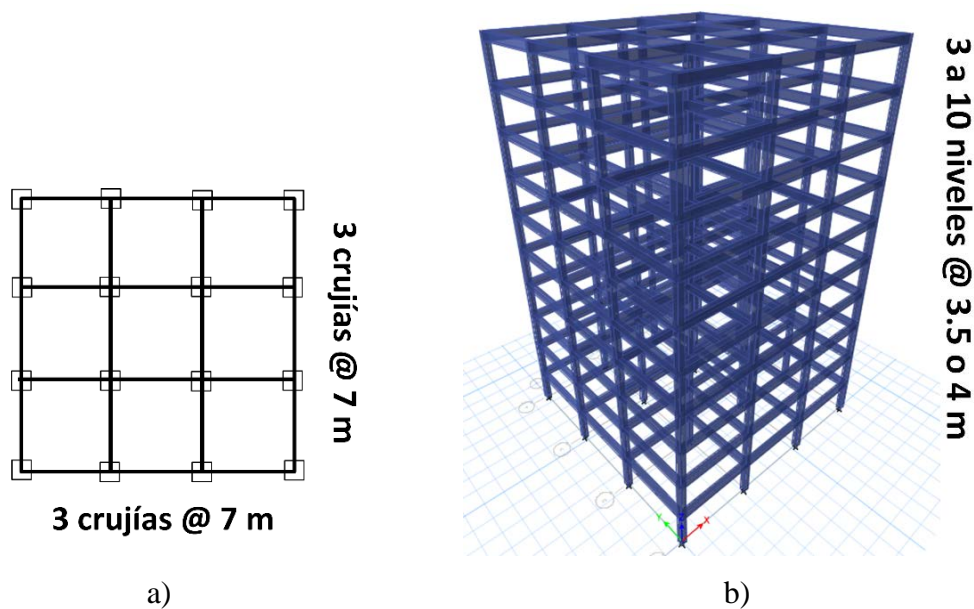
a) Planta, y b) Elevación de los edificios de concreto reforzado.
